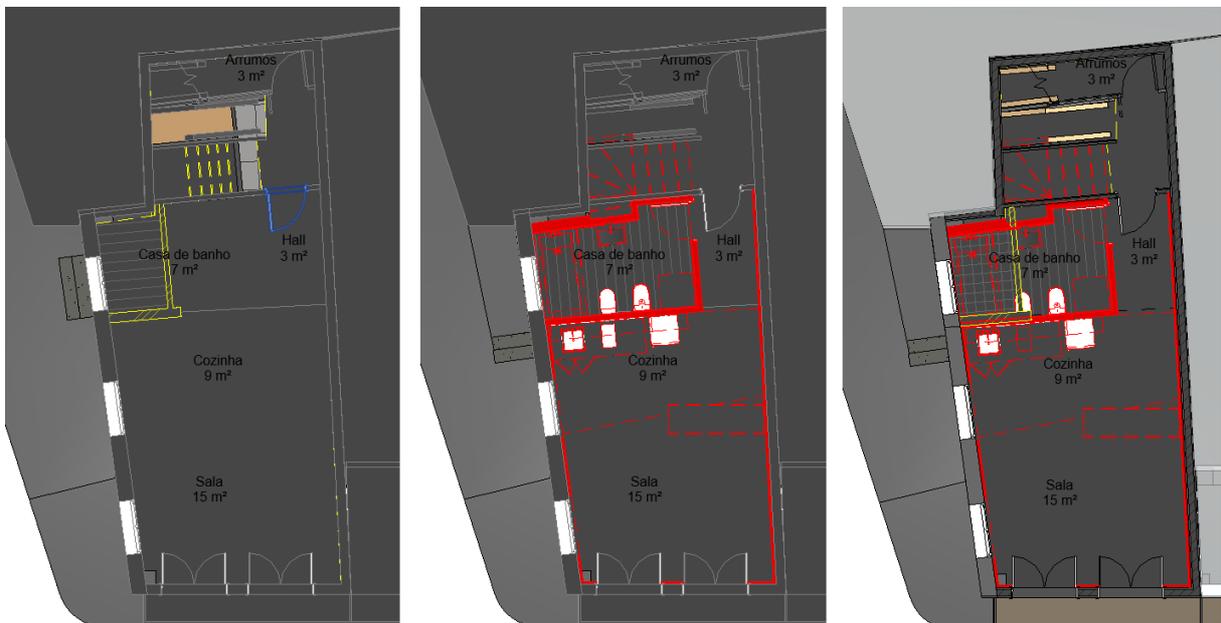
Plantas piso 1 - a demolir, a construir e vermelhos e amarelos
